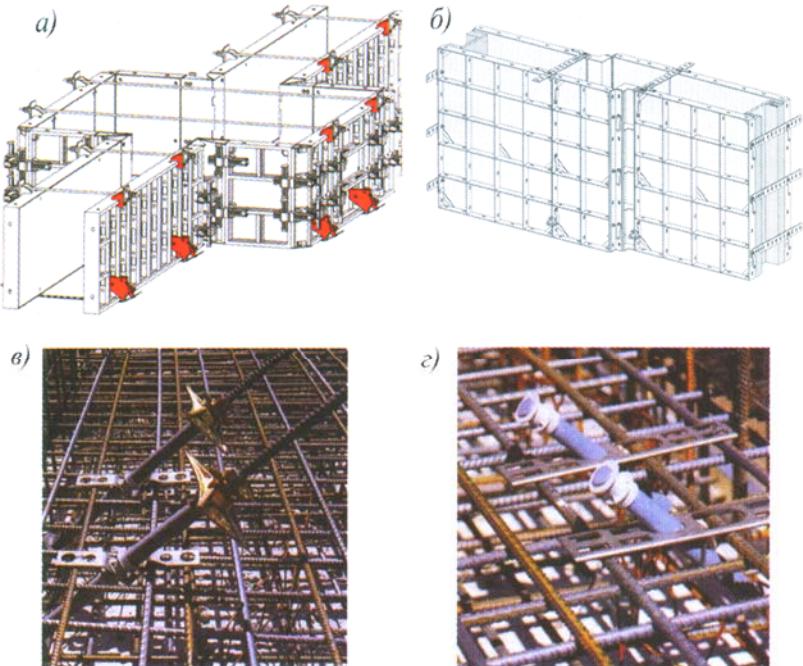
Анкерные тяжи: а - круглого сечения; б - плоского сечения; в - стяжной стержень опалубки PASCHAL; г - трубка ПХВ
